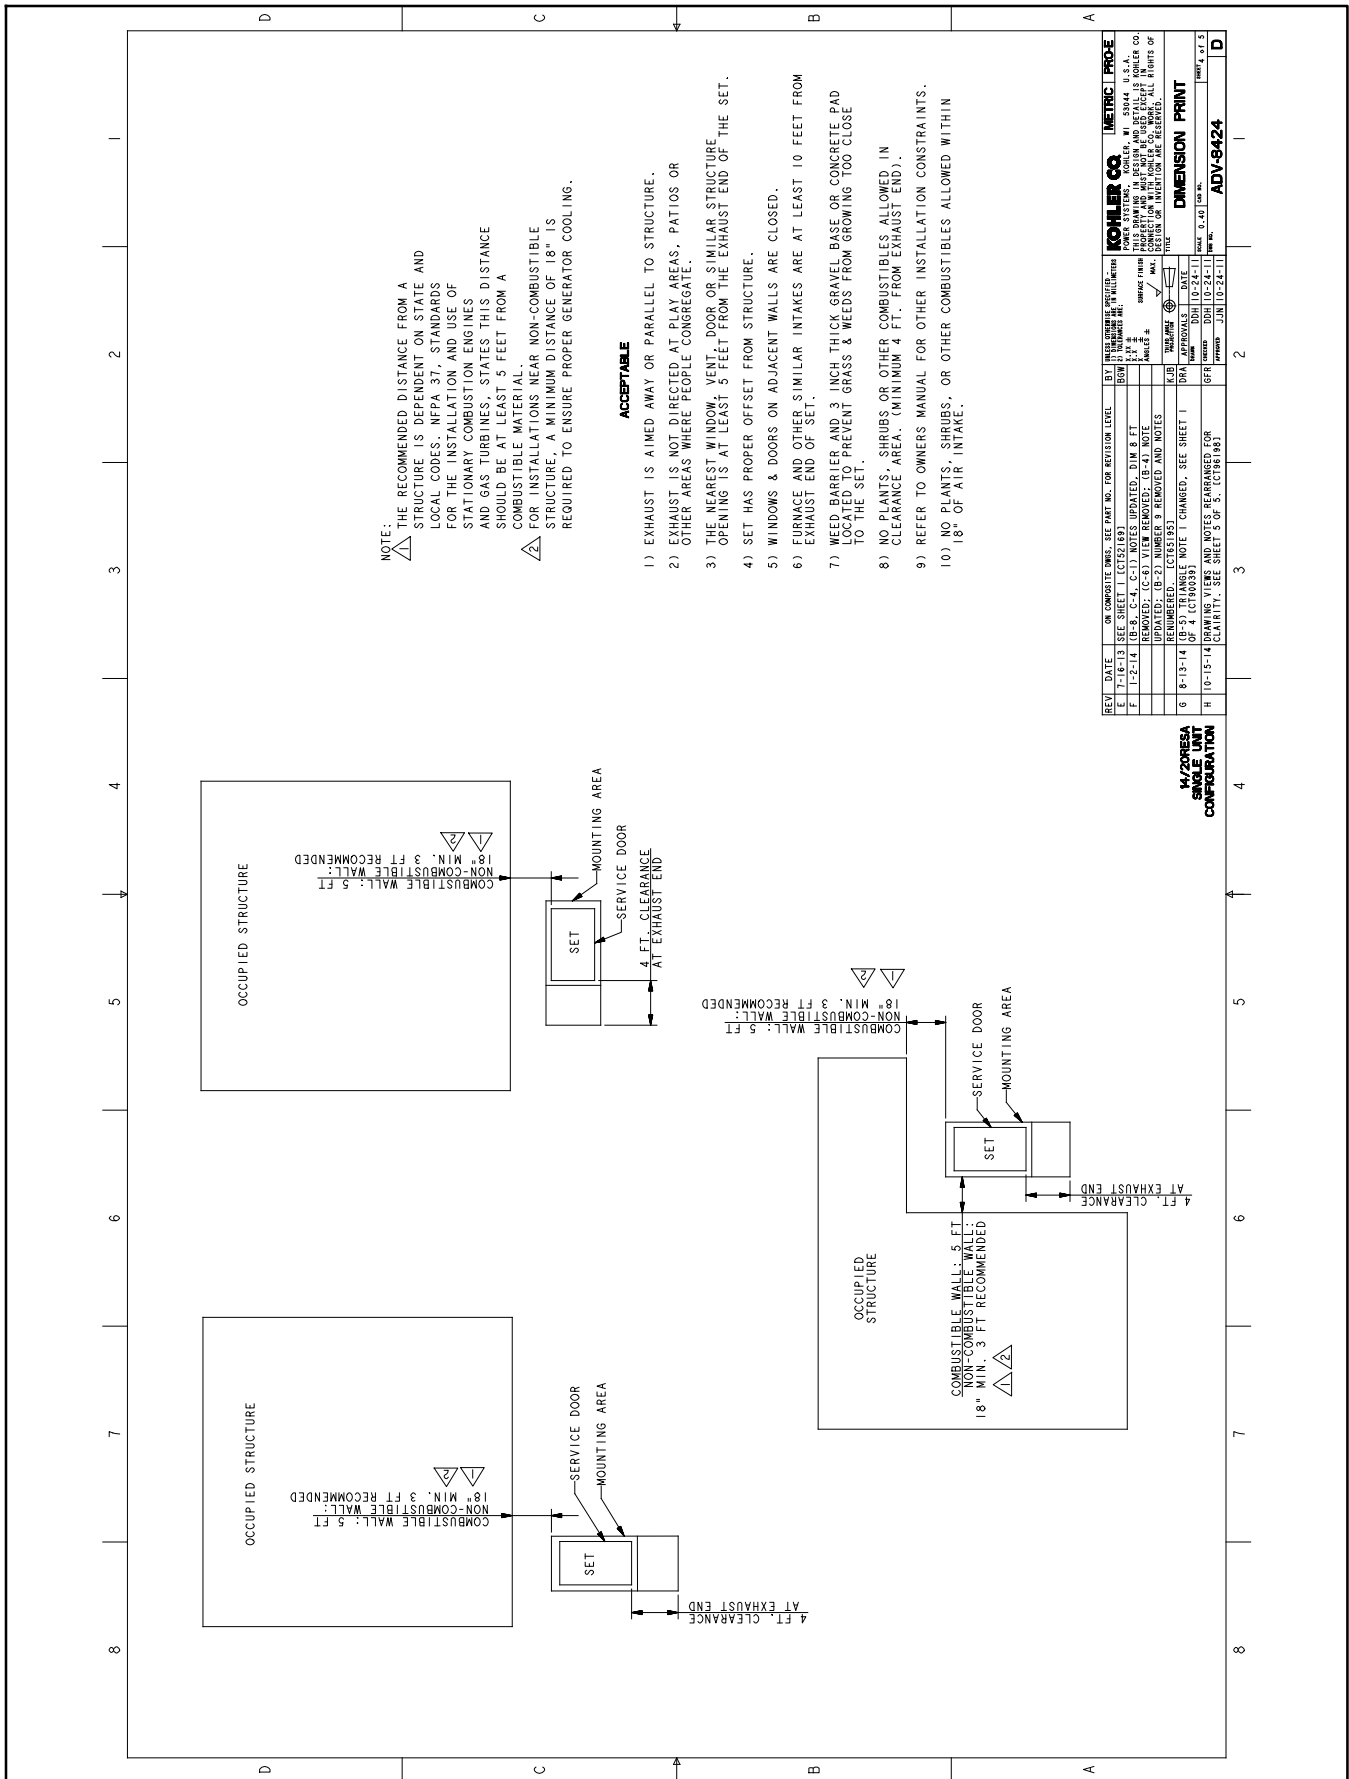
Размерный чертеж ADV-8424, лист 4 из 5
